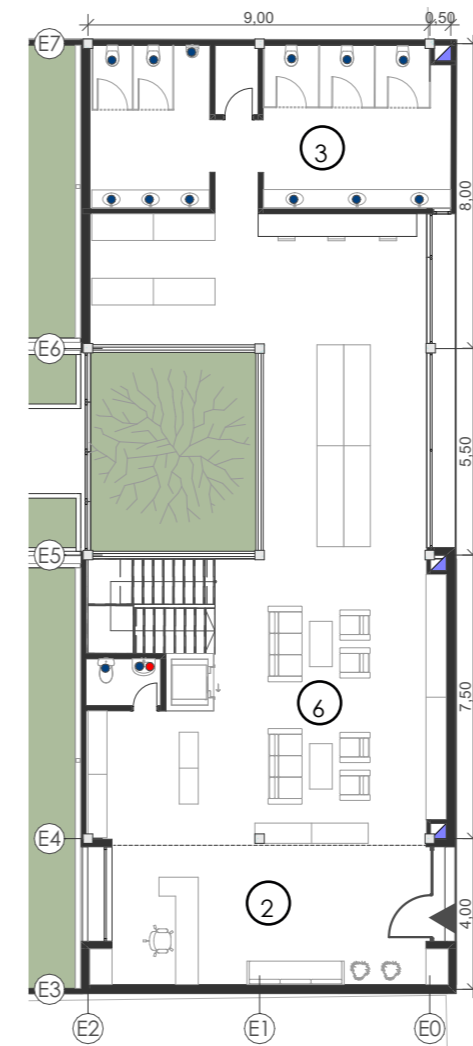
Planta Baja de la Biblioteca Elaboración propia (2026). Escala 1:200
